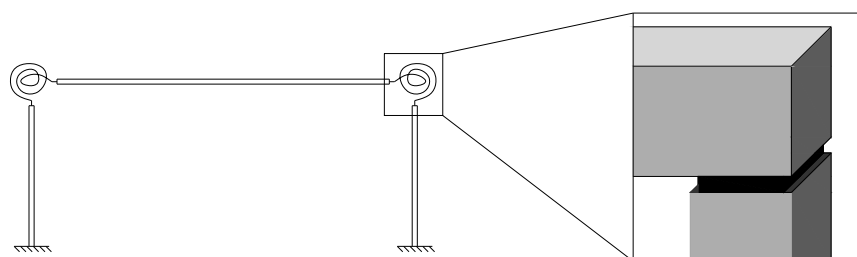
Ligação viga-pilar semirígida em edifícios de um pavimento (galpão).
